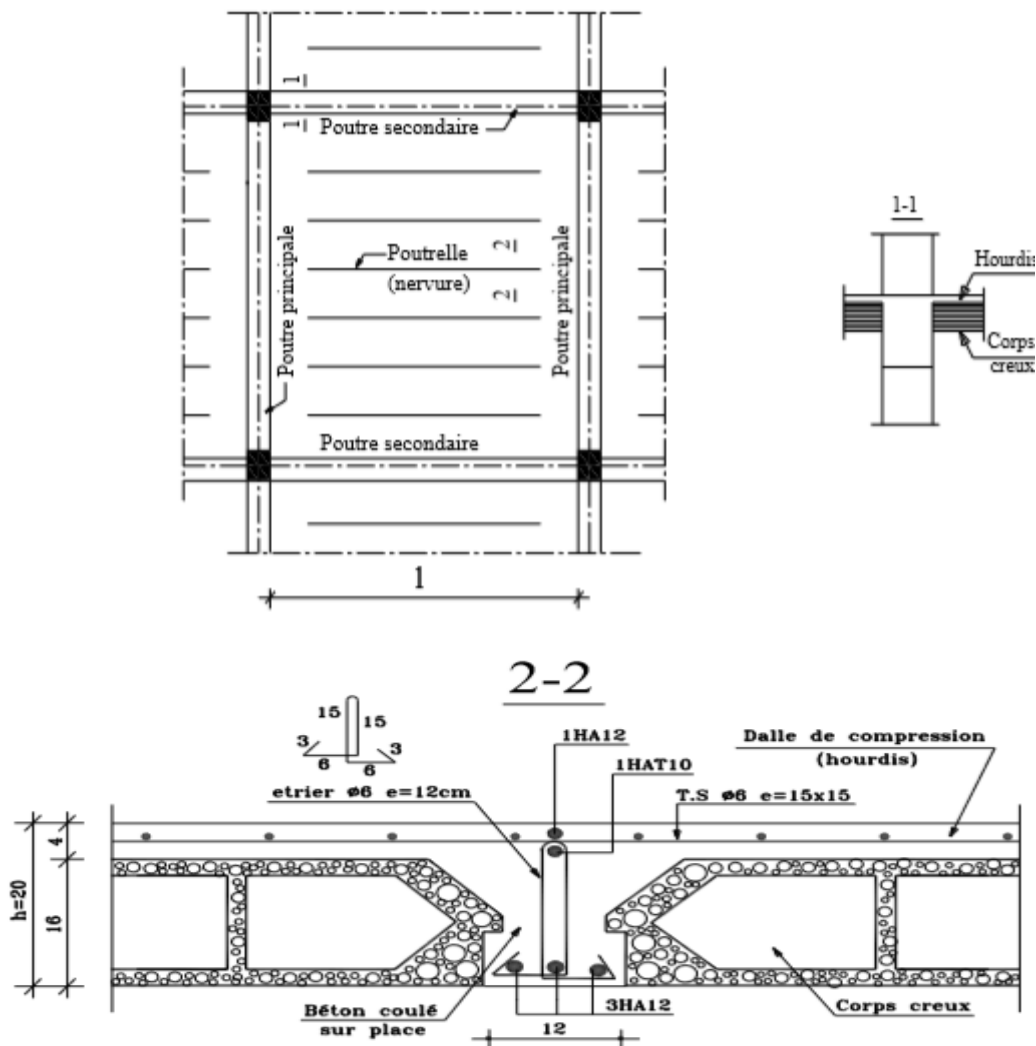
Plancher en corps creux coulé sur place [5]
